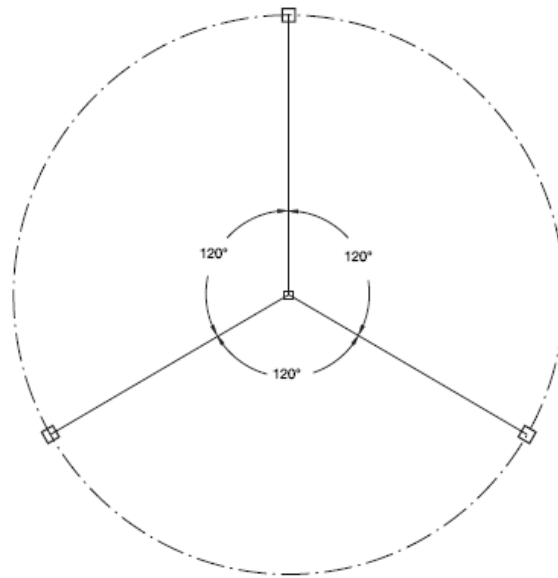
Torre arriostrada vista en planta (disposición de los cables)
